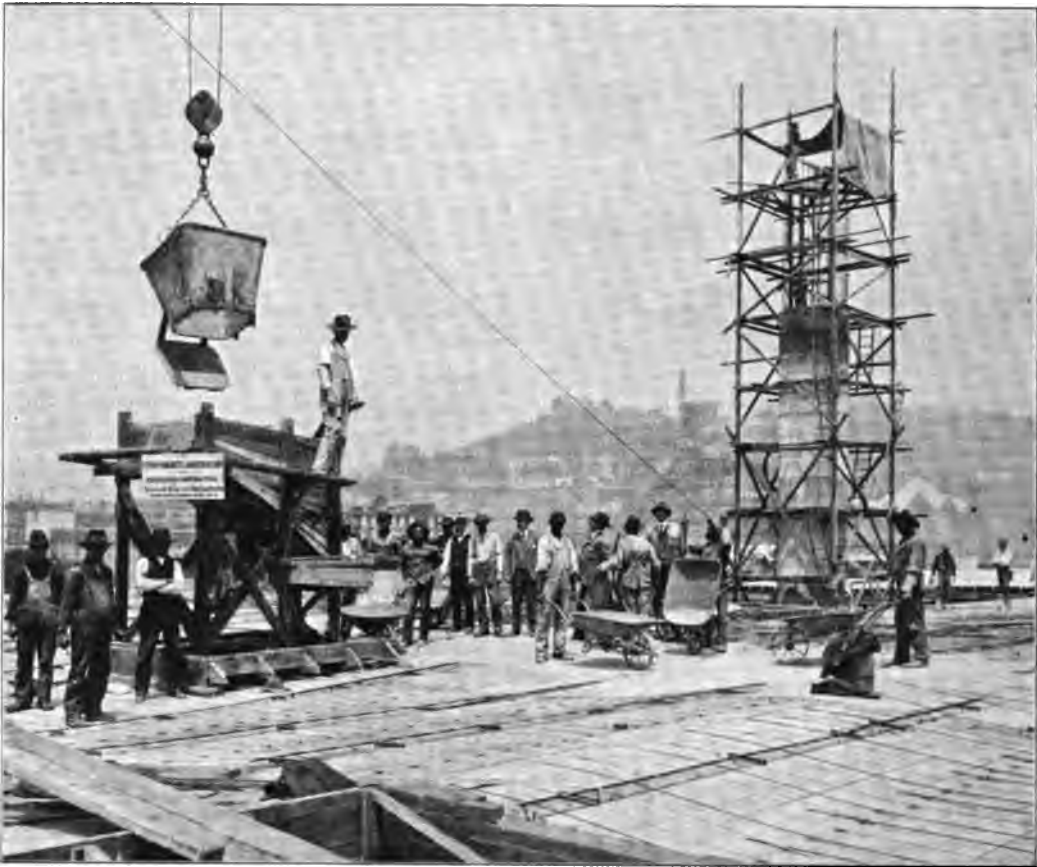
Eiserner Aufzugskübel mit beweglichem Boden und Einfüllvorrichtung in Schubkarren.
